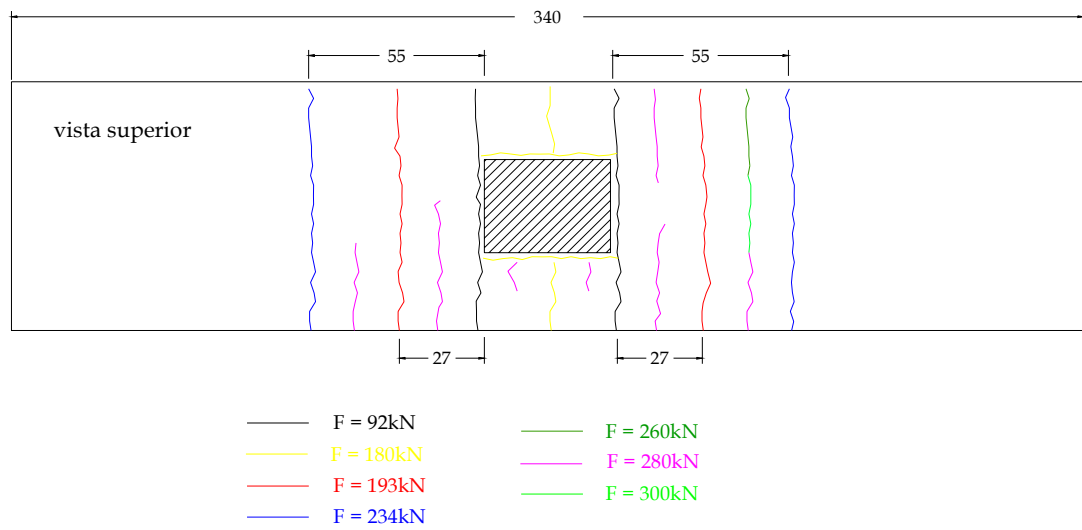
Fissuras na vista superior do modelo 2.1 - carregamentos.
